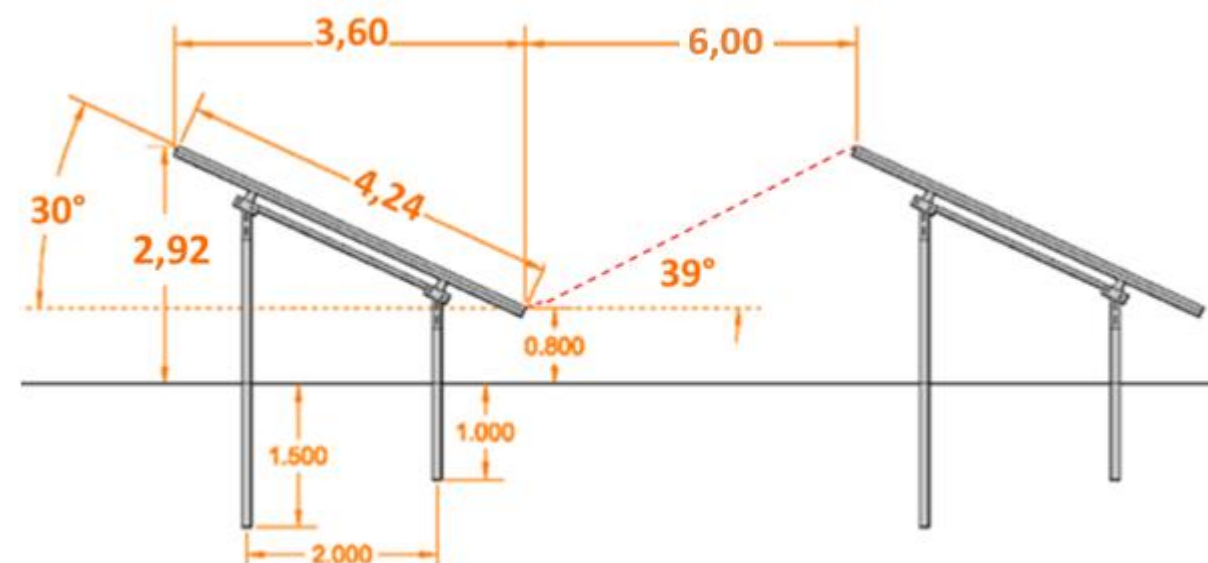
Plan des structures solaires pour la partie culture maraichère
